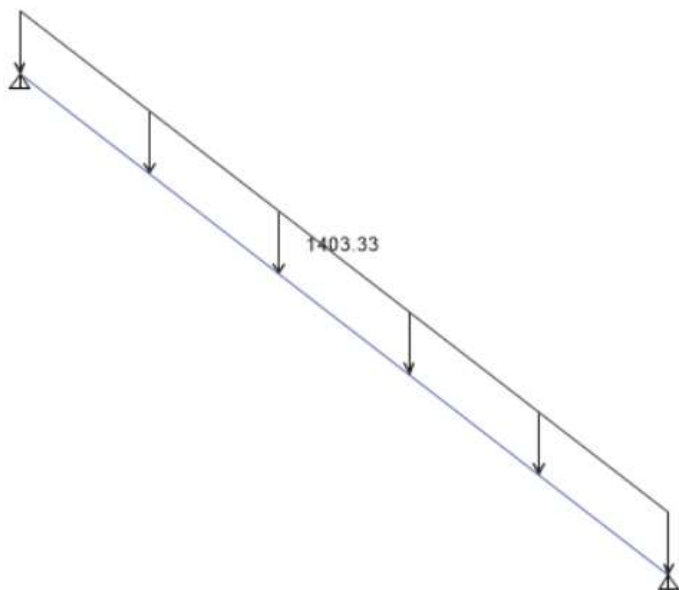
Concreto Armado, cargas últimas aplicadas en escalera tramo 1
